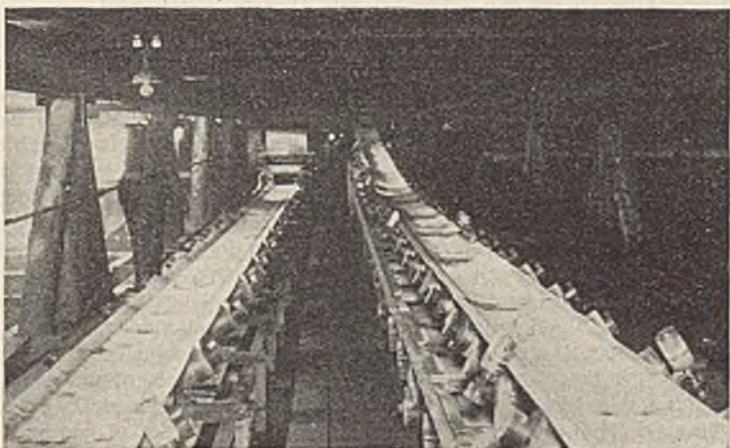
Ortsfestes und bewegliches Band auf der ersten Steifenlage im Tunnelabschnitt Brunnenstraße Berlin.
